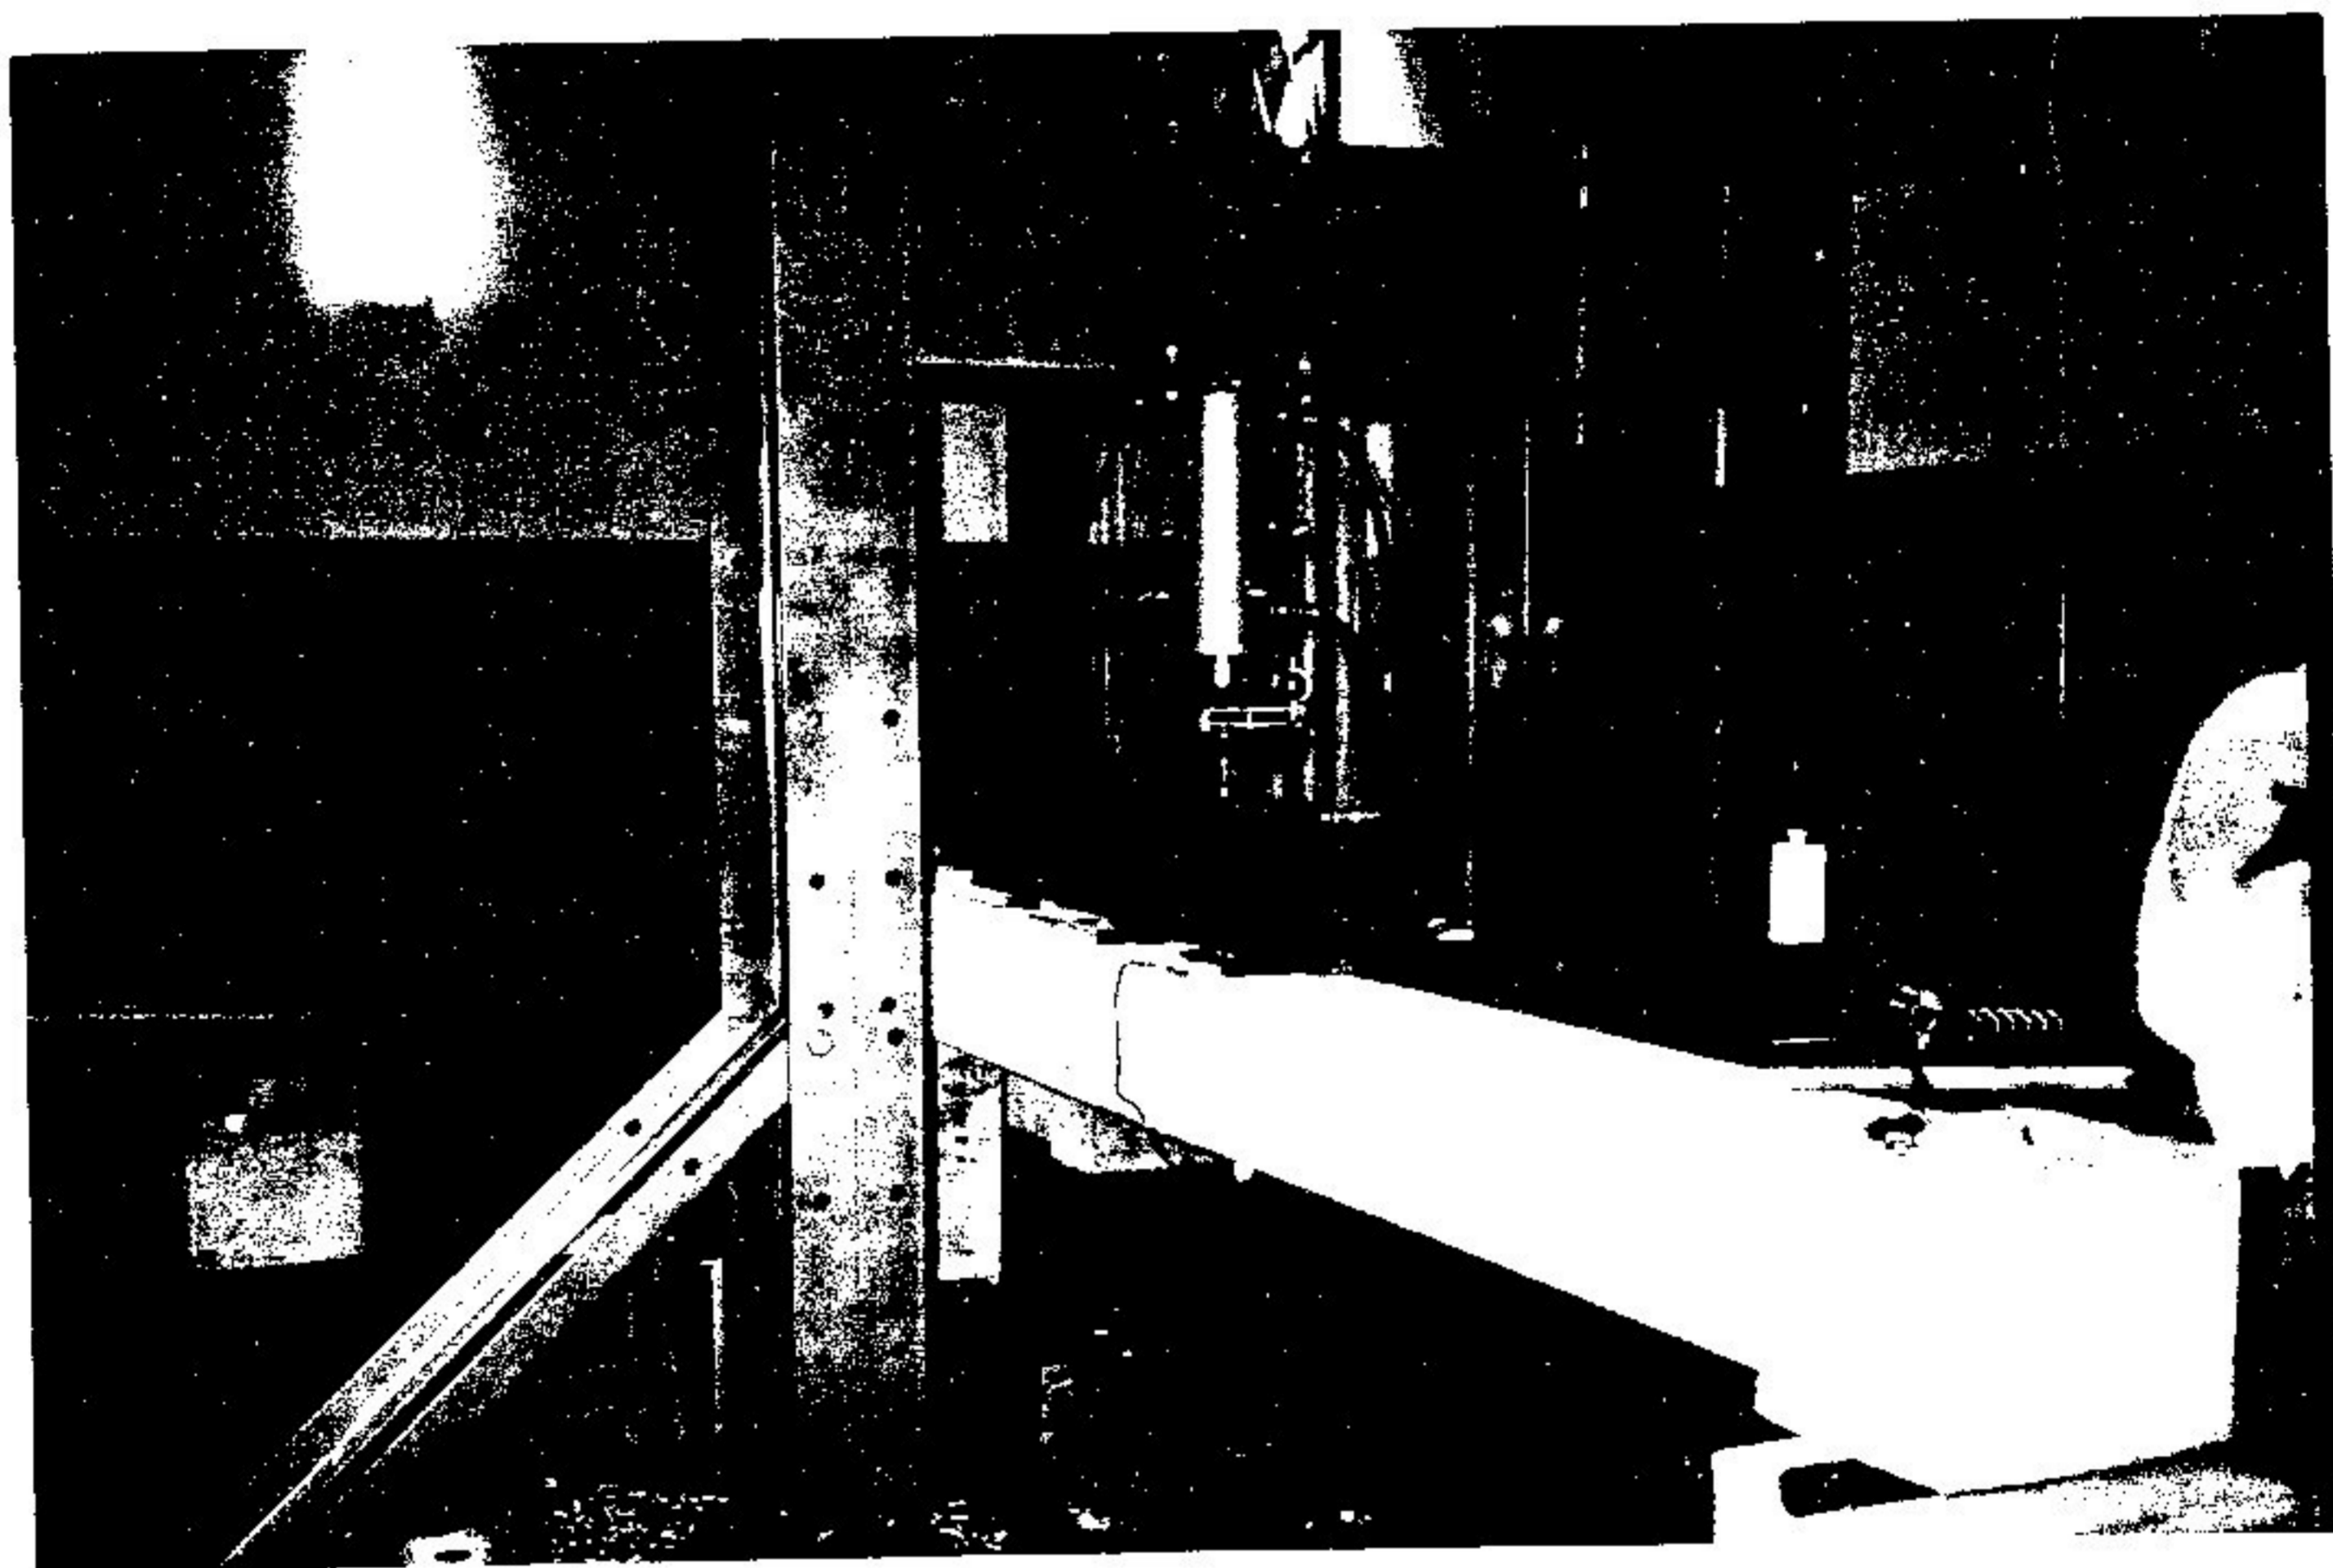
Dispositivo de ensaio do LAEES da EE.UFMG, utilizado para o estudo de vigas em concreto de alta resistência.
